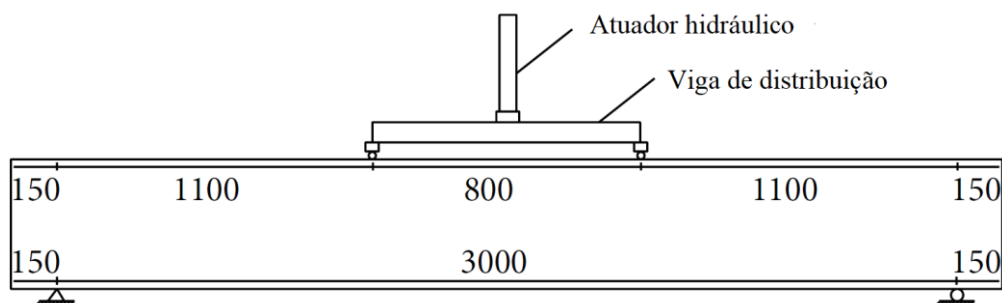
Dimensões das vigas de LIU e ZHOU (2016), em mm.
